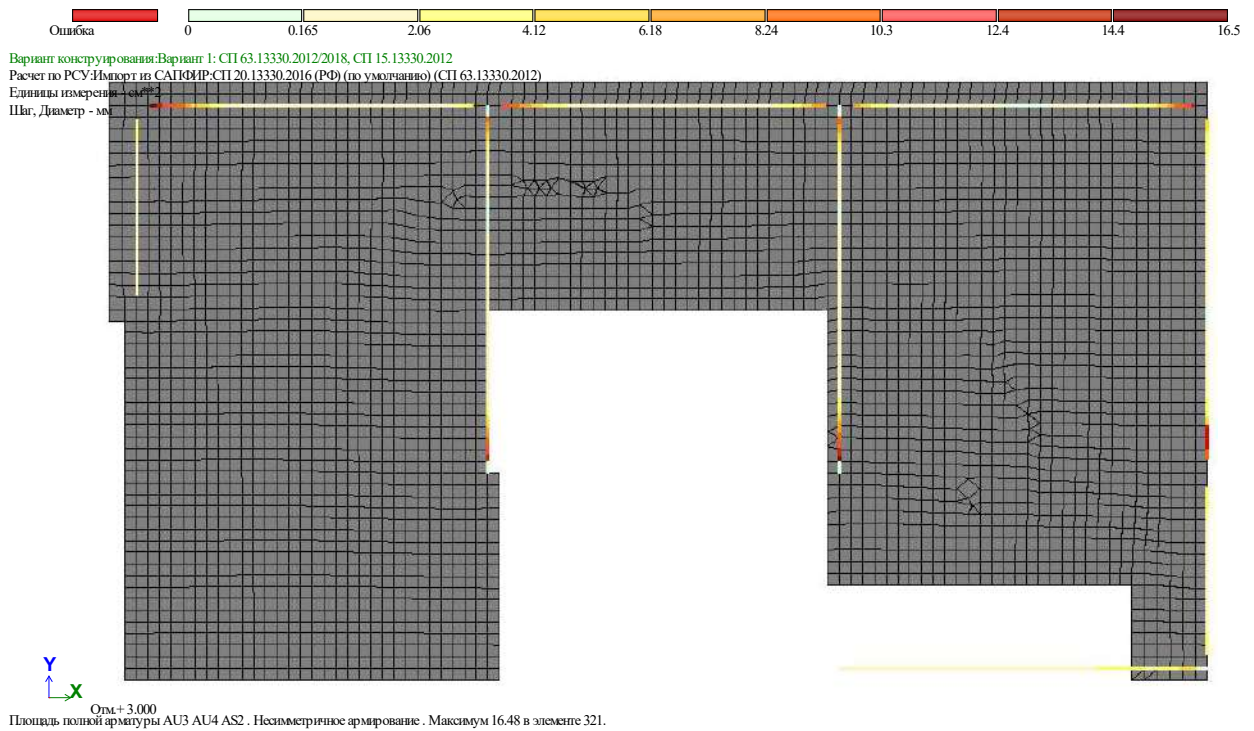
Суммарная арматура балок плиты перекрытия 1-го этажа.
